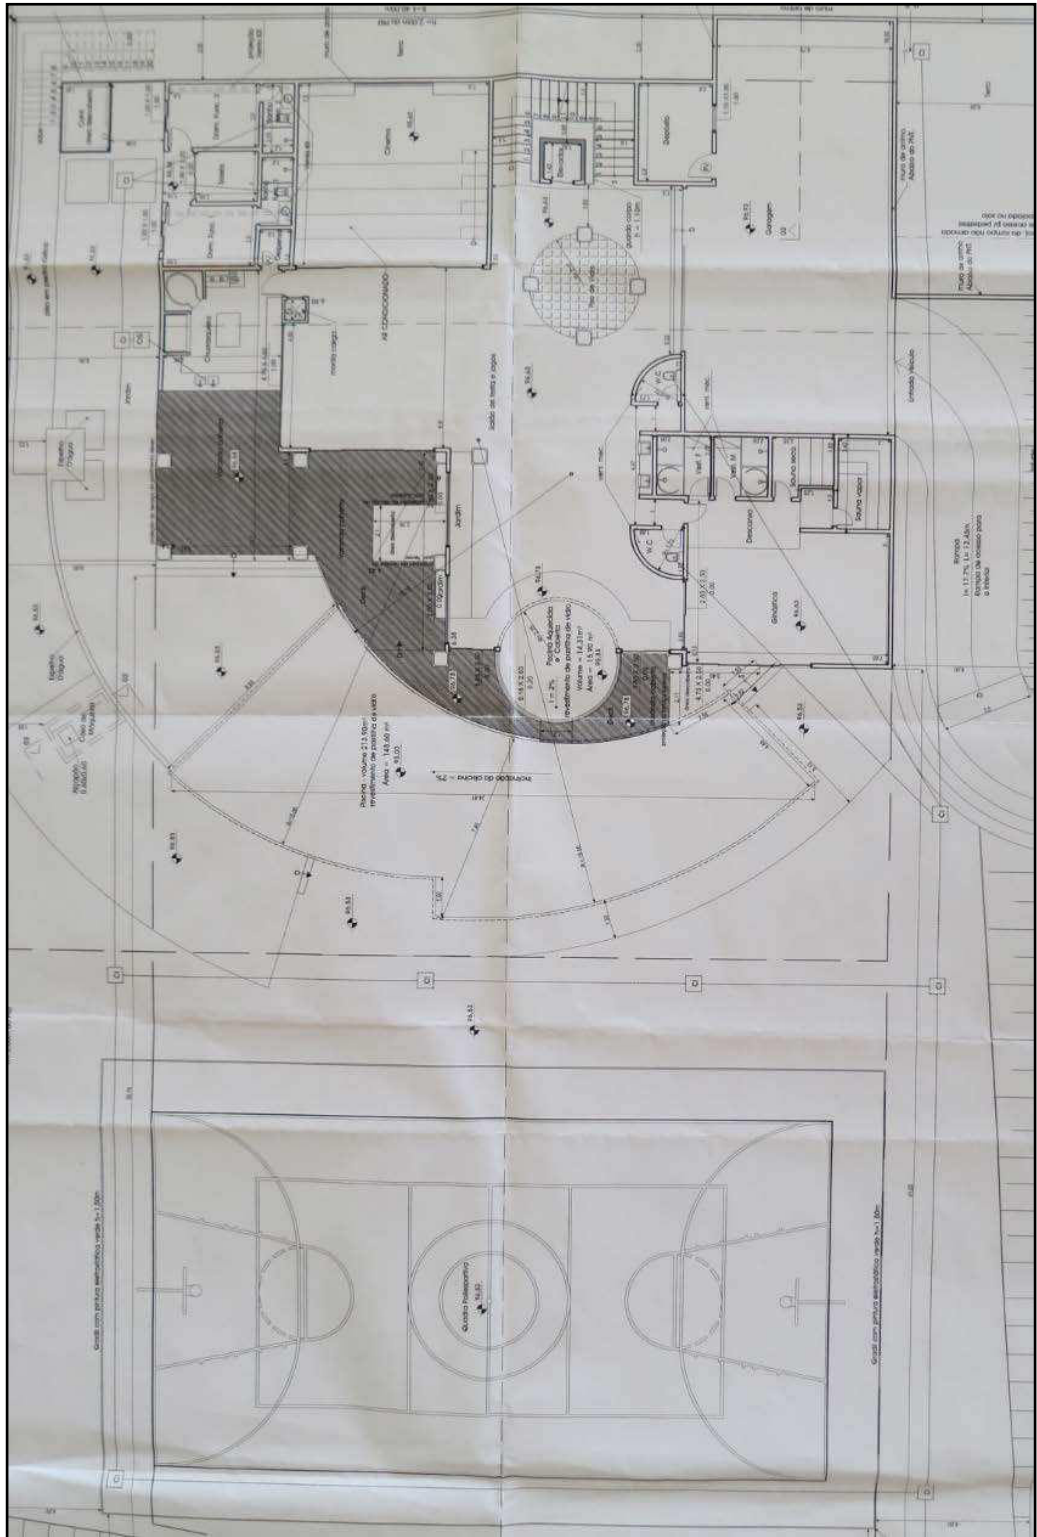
Cópia da planta do pavimento da cota 96,63 (área de lazer).
